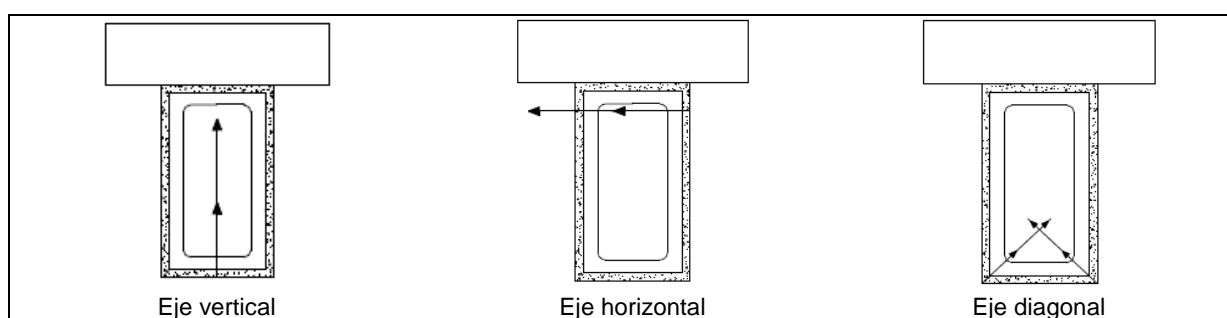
Dirección dentro de las vigas<sup>8</sup>.
